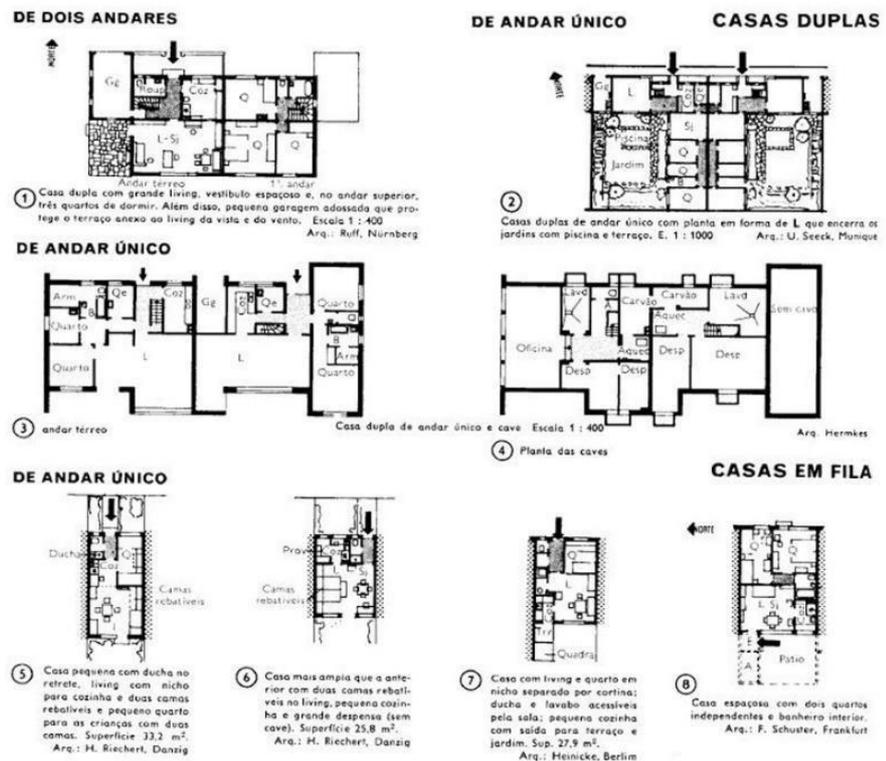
Instruções técnicas e dimensionamentos para arquitetura e construção
